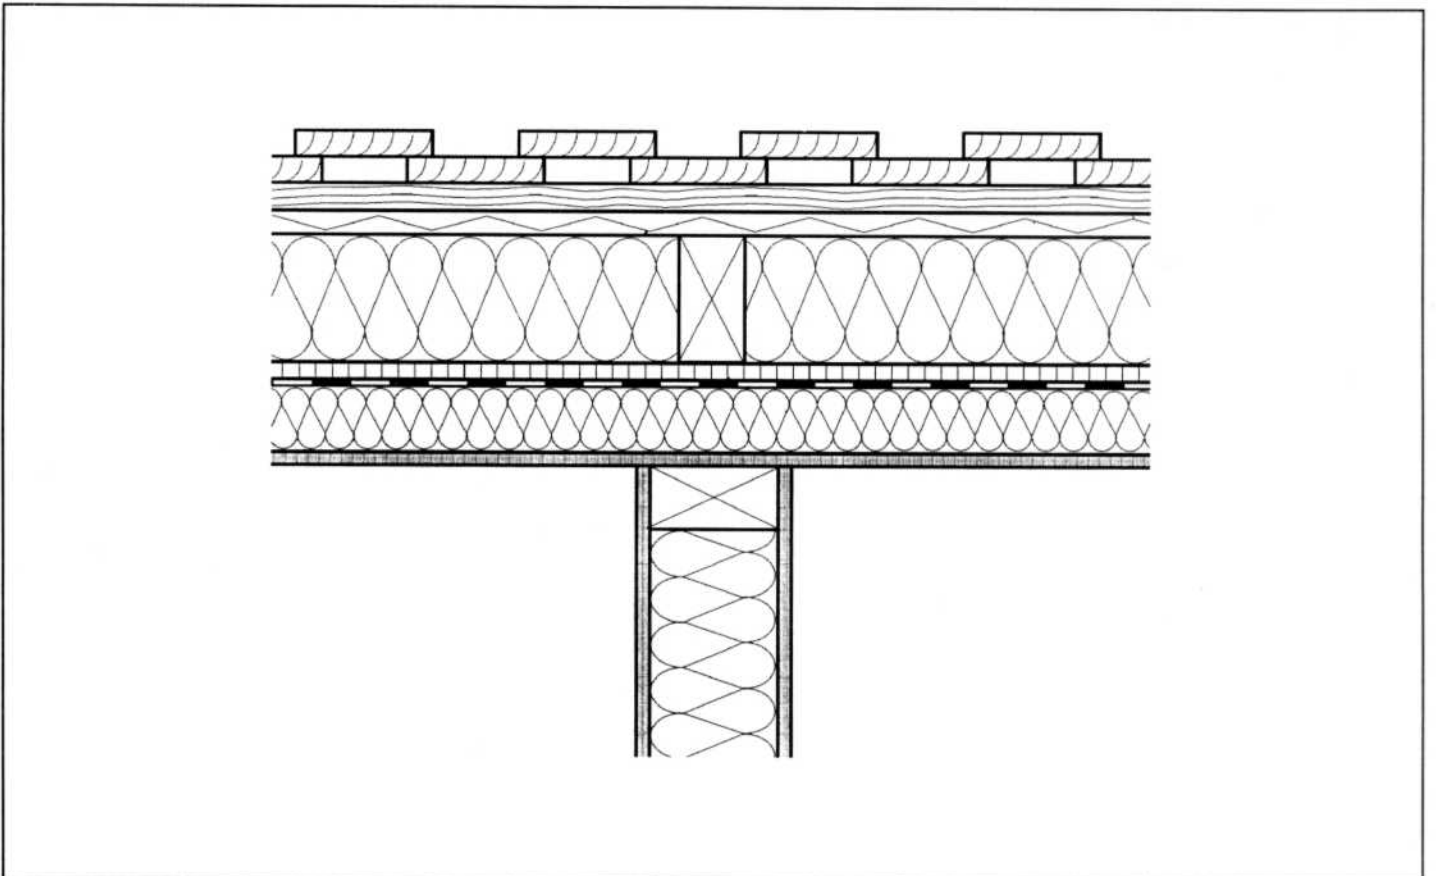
Geschoßdeckenanschluß mit Balkenträger für die Außenwand W 8 und die Geschoßdecke G 1.
